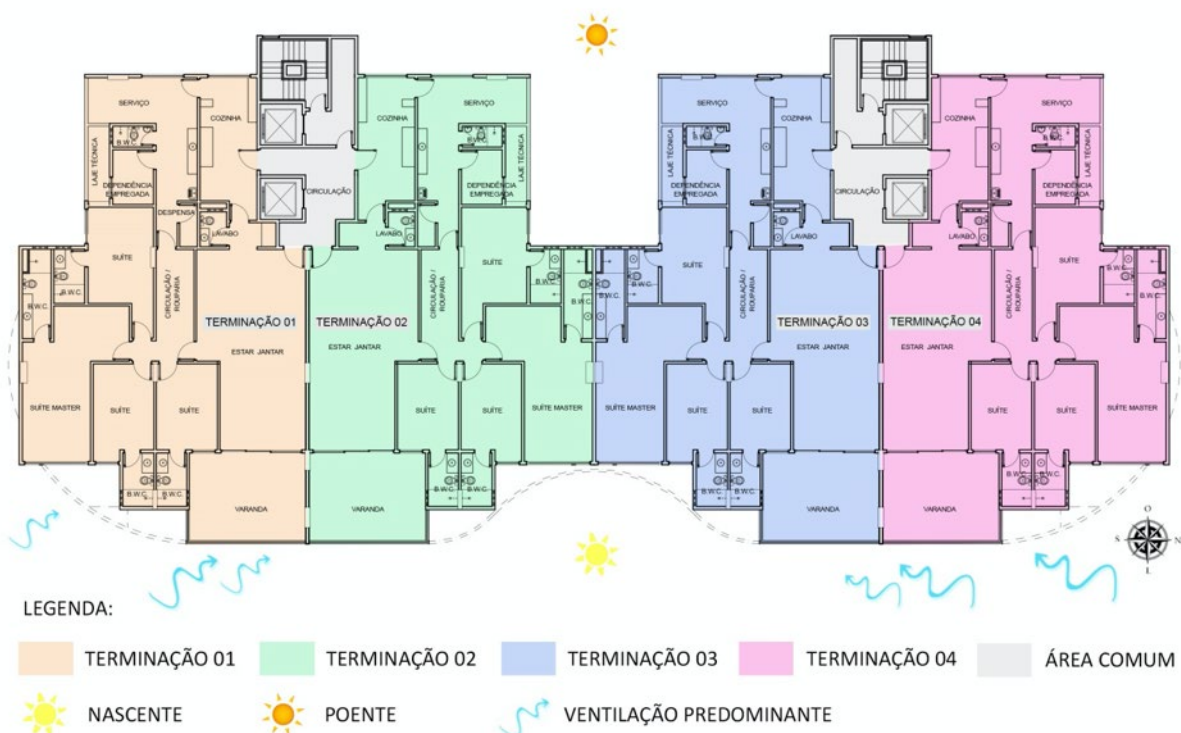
Planta baixa do pavimento tipo do edifício Genova, condomínio Riviera Del Mare
